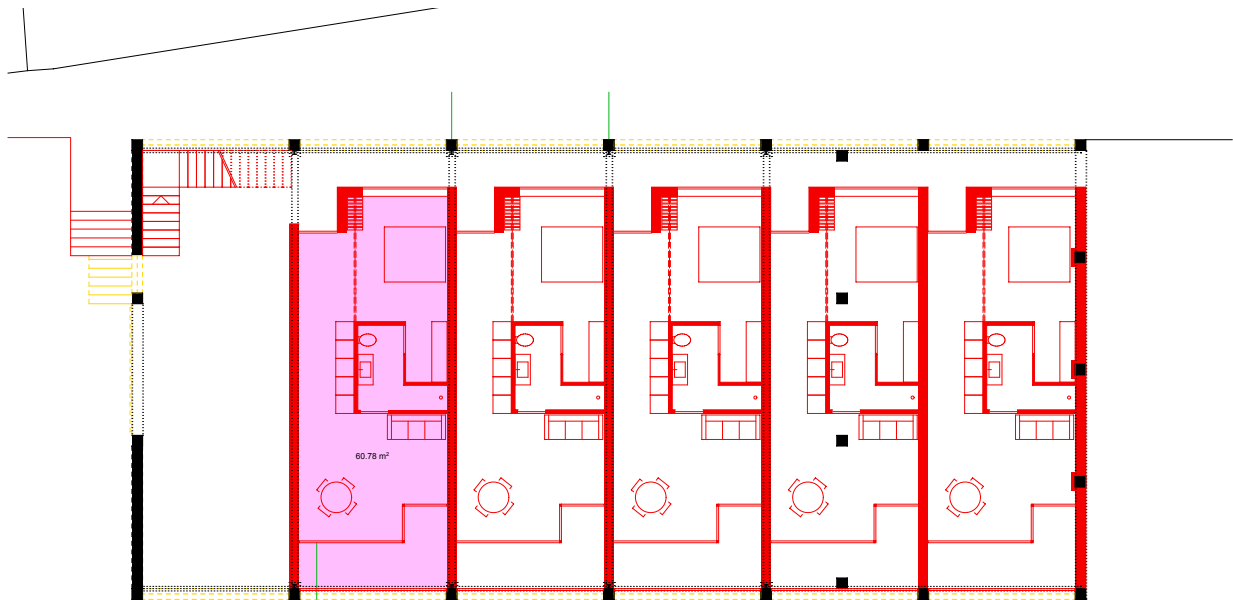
Grundriss Erdgeschoss, TK 7 am 23.11.2023
